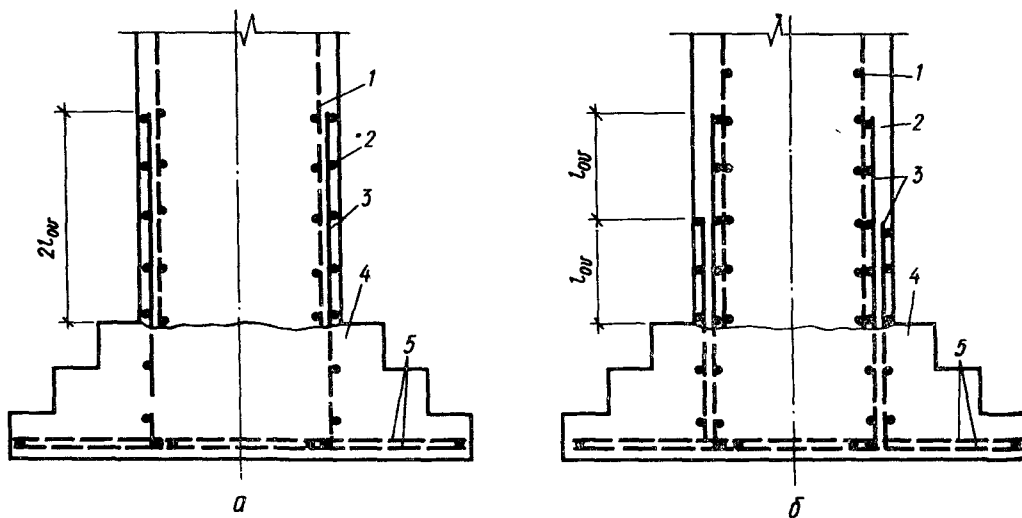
Устройство стыков растянутых стержней внахлестку в фундаментах колонн при раздельном бетонировании ступенчатой части фундамента и подколонника:
